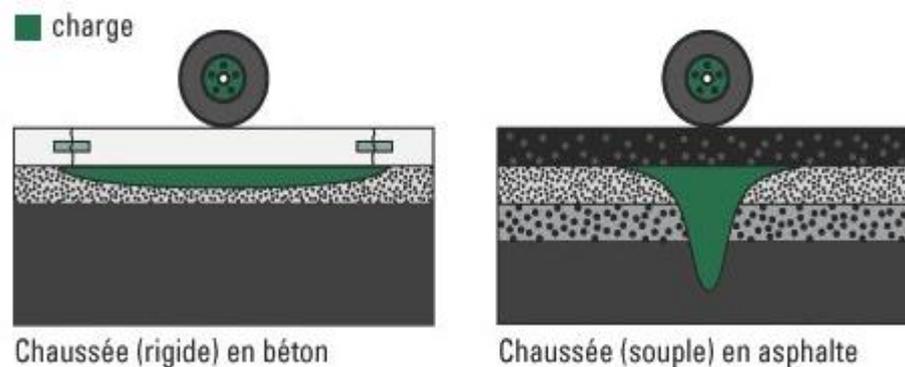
répartition de la charge sur la chaussée en béton et la chaussée en asphalte
